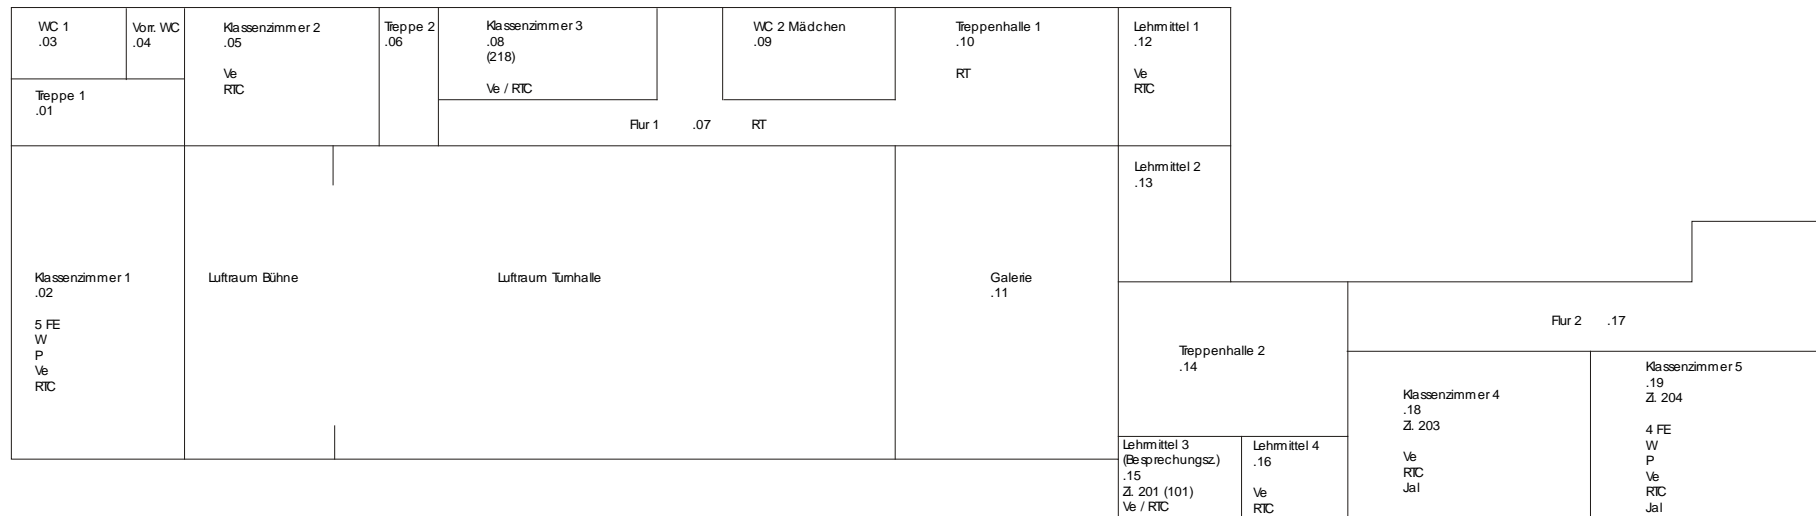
Bauteil 1- Räume Erdgeschoß mit DDC-Nummerierung und Messstellen
